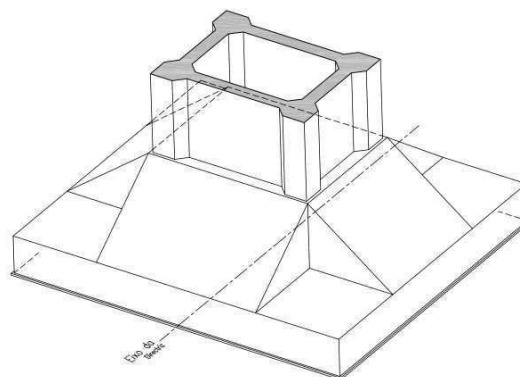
PROC – Perspetiva das sapatas dos pilares [8]
